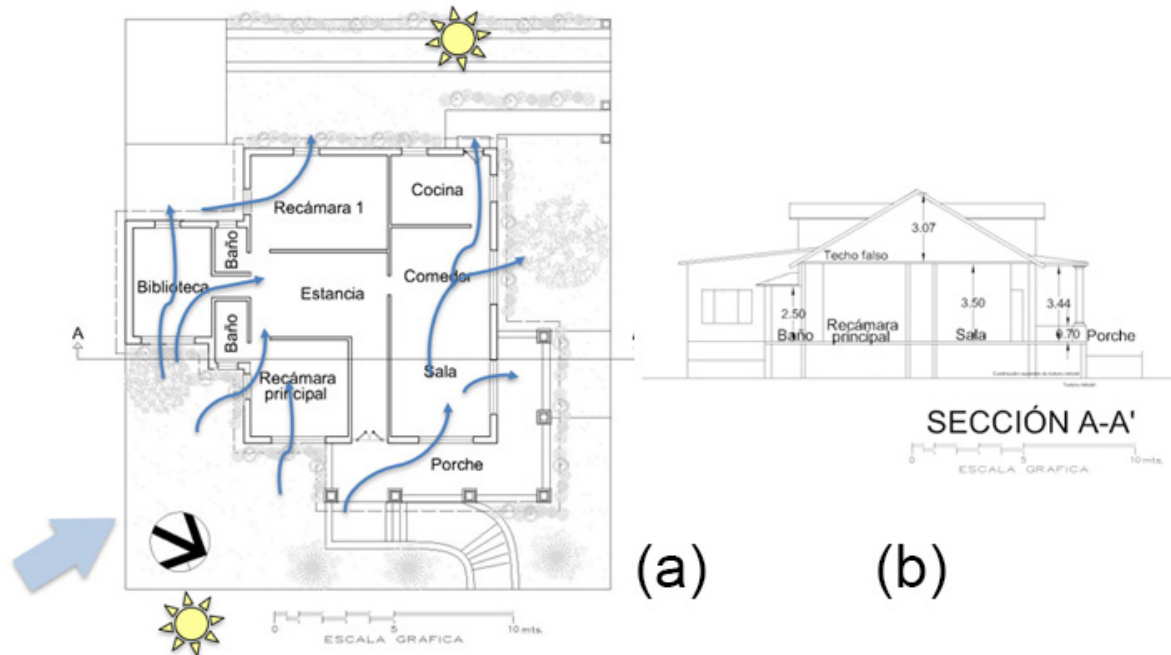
(a) Planta arquitectónica (b) Corte. Fuente. Elaboración de los autores
